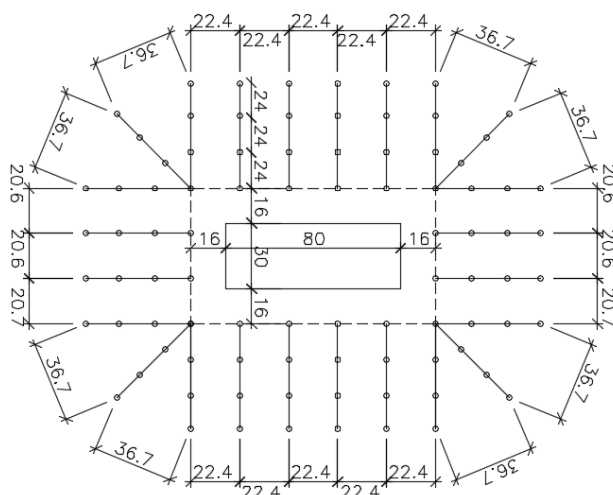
Armadura de cisalhamento ao redor do pilar P27 – Medidas em cm
